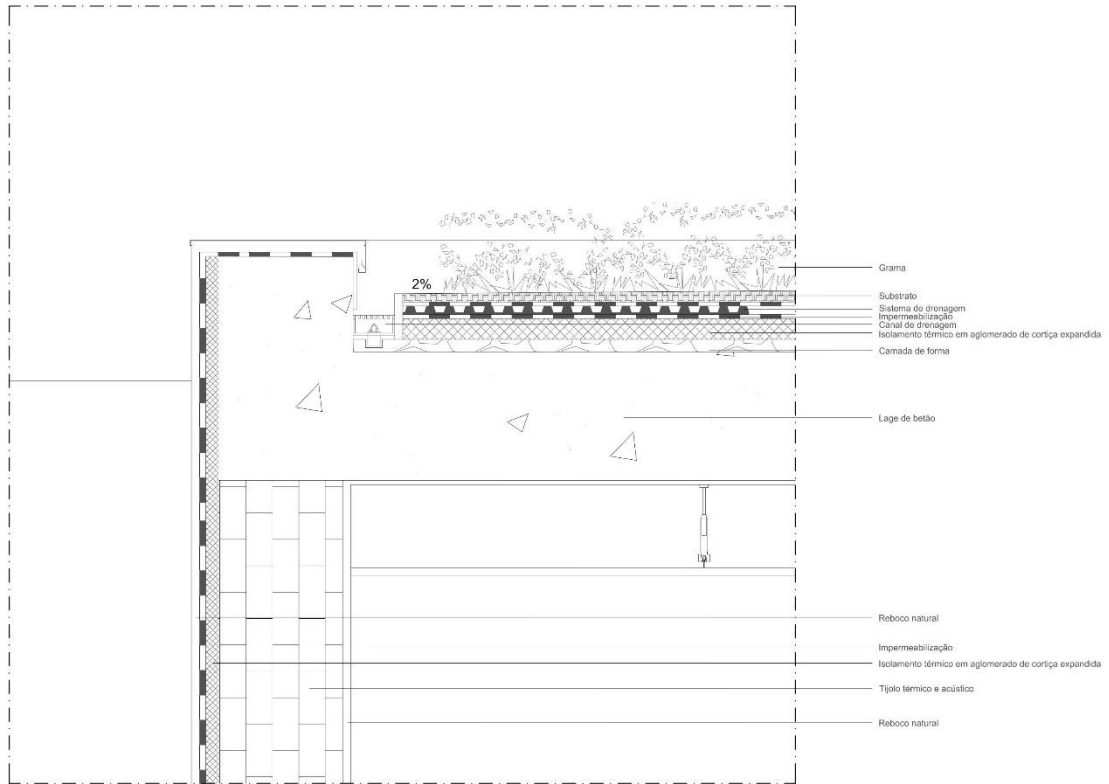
, PORMENOR CONSTRUTIVO DA COBERTURA AJARDINADA
